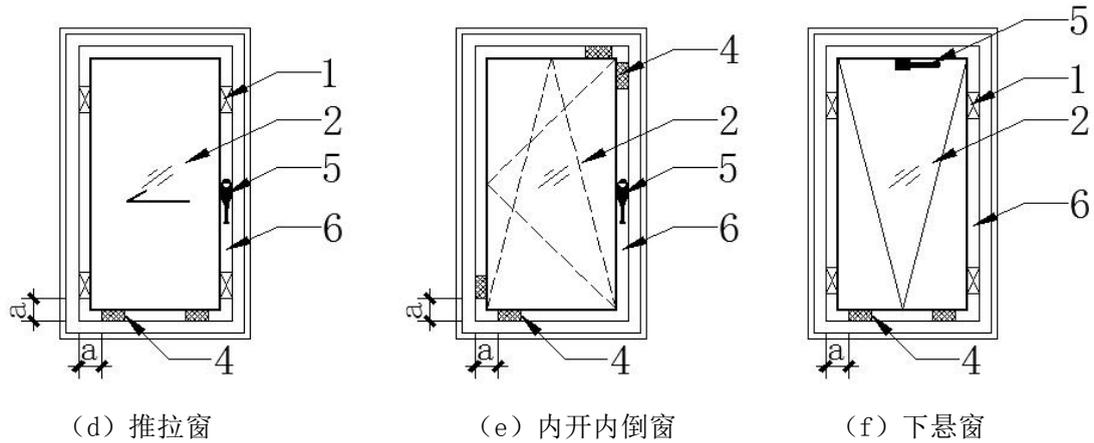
玻璃支撑垫块和定位垫块安装位置示意
